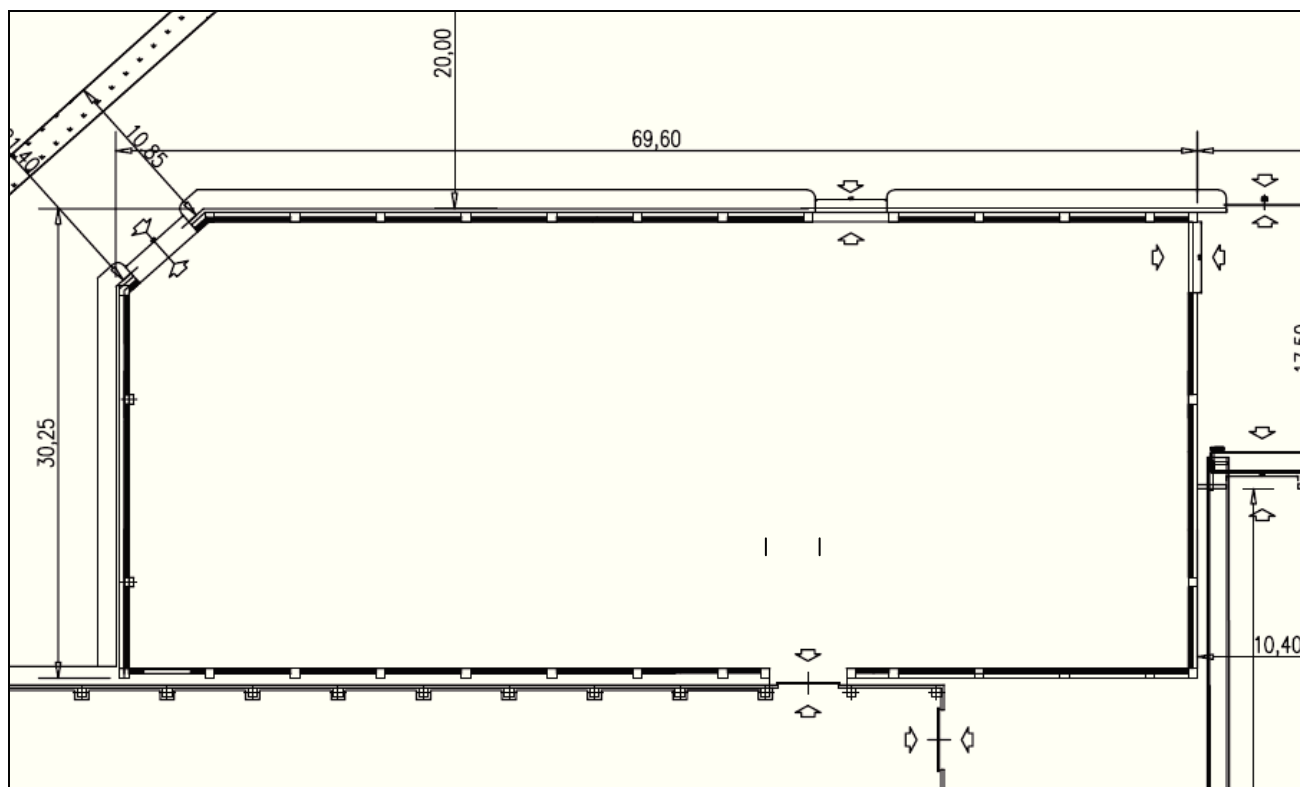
Stralcio planimetrico del nuovo edificio per la seconda maturazione
